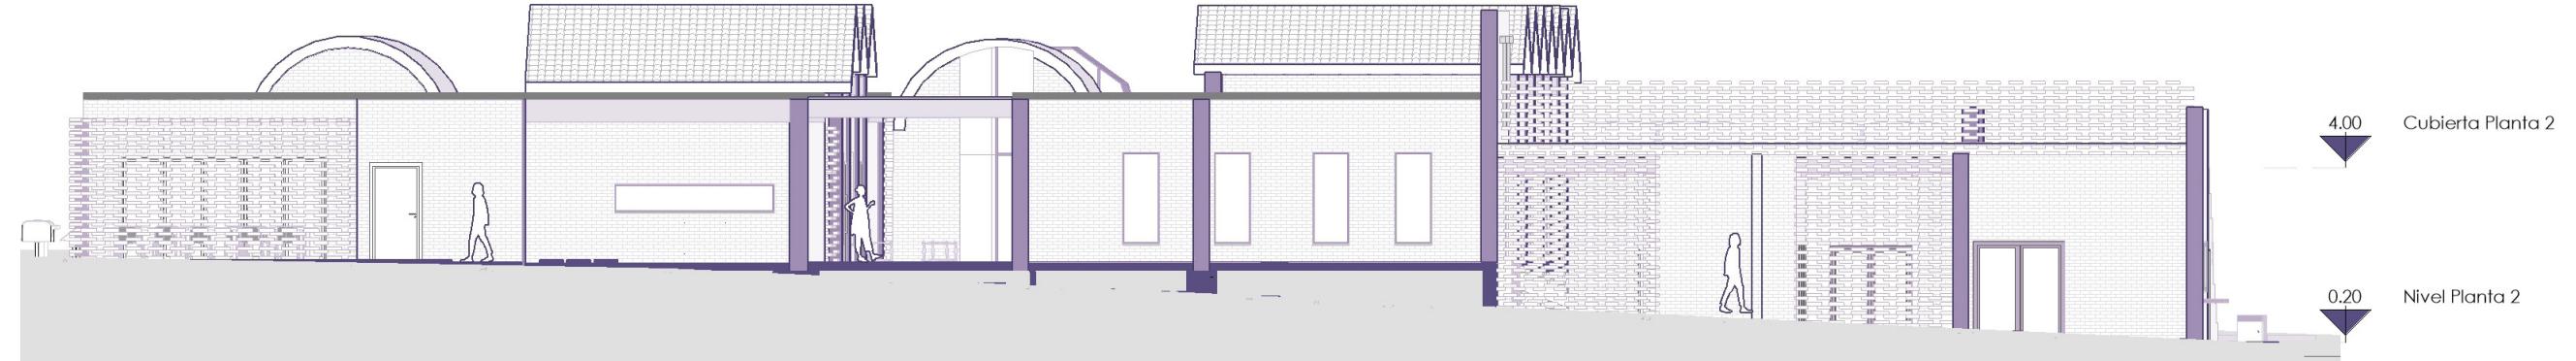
Fachada Lateral Derecha - Elaborado por el autor.
